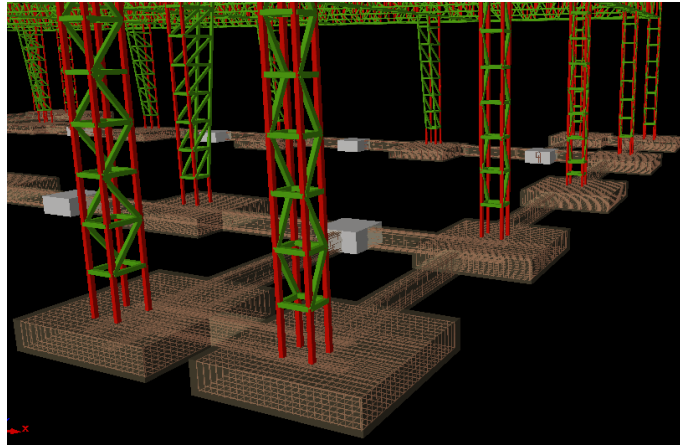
| Zapatas vinculadas por medio de vigas de fundación
